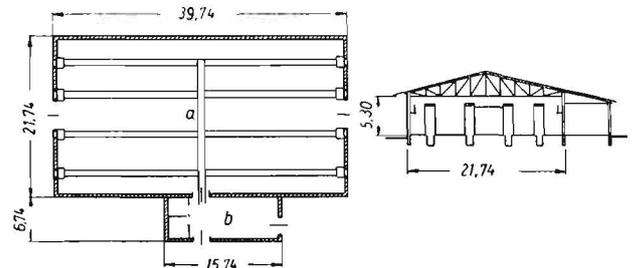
Kartoffellagerhalle Vorentwurf Gr. Lüsewitz; a Lagerhalle, b stationäre Sortierung
